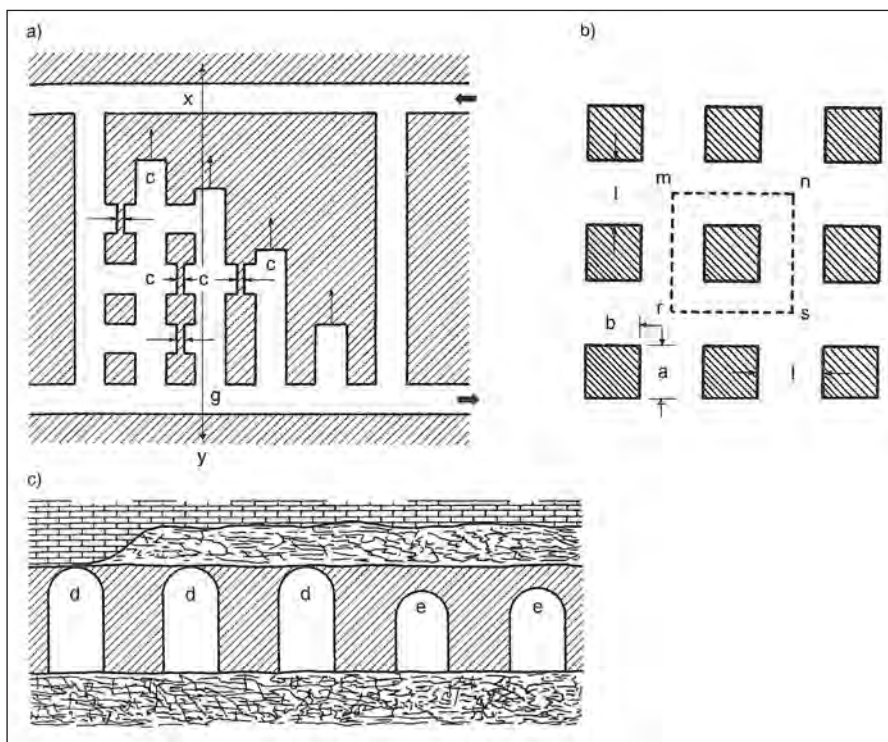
La coltivazione a camere e pilastri: a) Pianta; b) Particolare del rapporto fra pieni e vuoti per il recupero del minerale; c) Sezione verticale; d) Volta del cantiere coincidente con tetto sterile; e) Volta del cantiere in minerale a protezione del tetto franoso.
